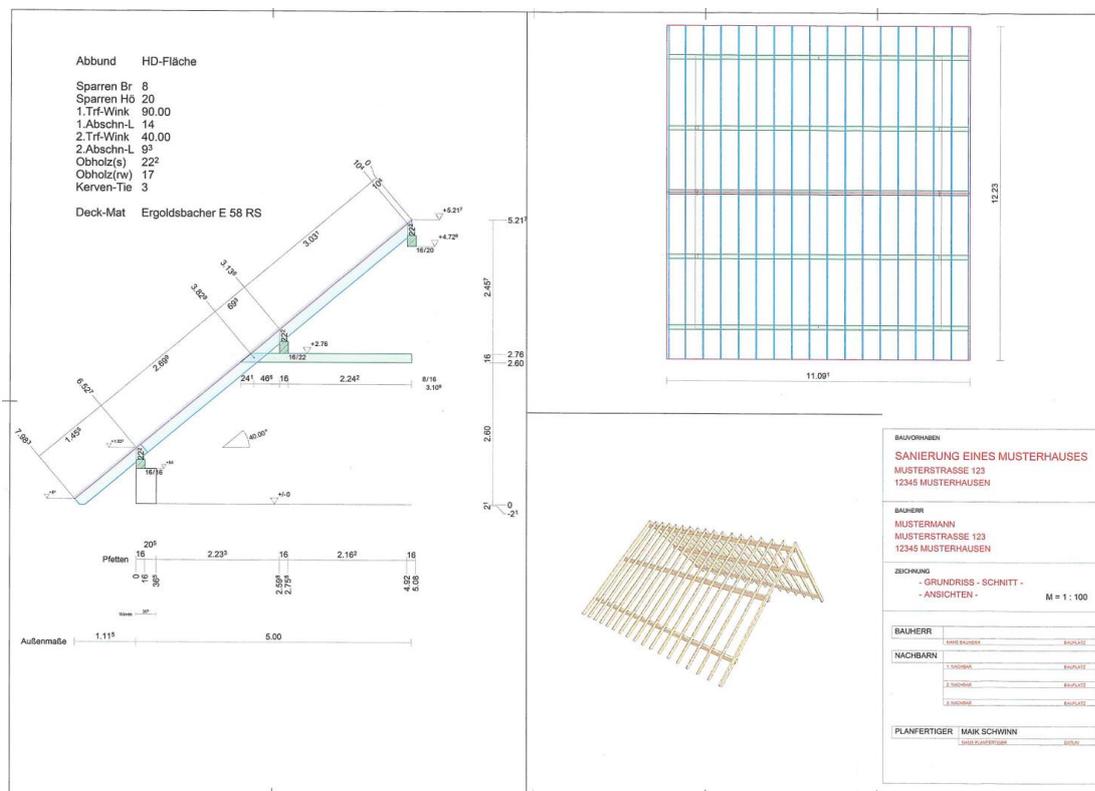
Grundriss und Planung der Voll- und Teilsanierung des Musterdaches<sup>61</sup>
